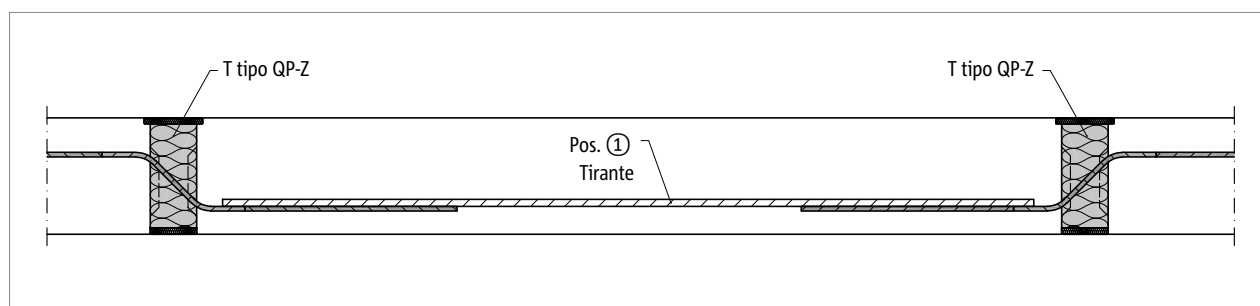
Schöck Isokorb® T tipo QP-Z: raccordo armatura tirante
